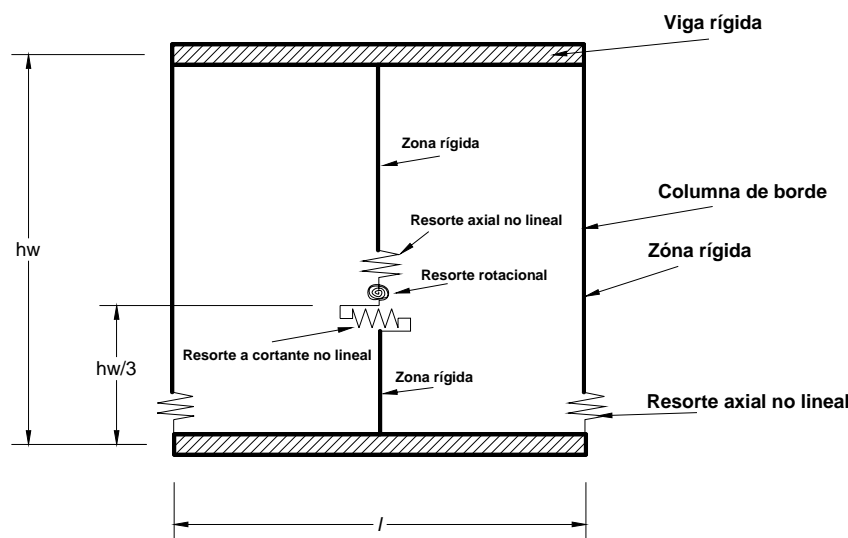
Macromodelo propuesto para muros esbeltos y robustos de concreto reforzado
